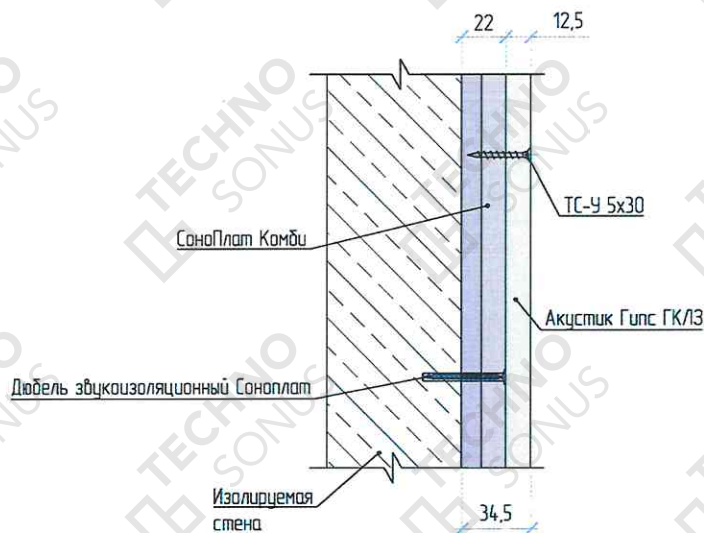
Конструкция бескаркасной системы звукоизоляции стены «Слим П»
